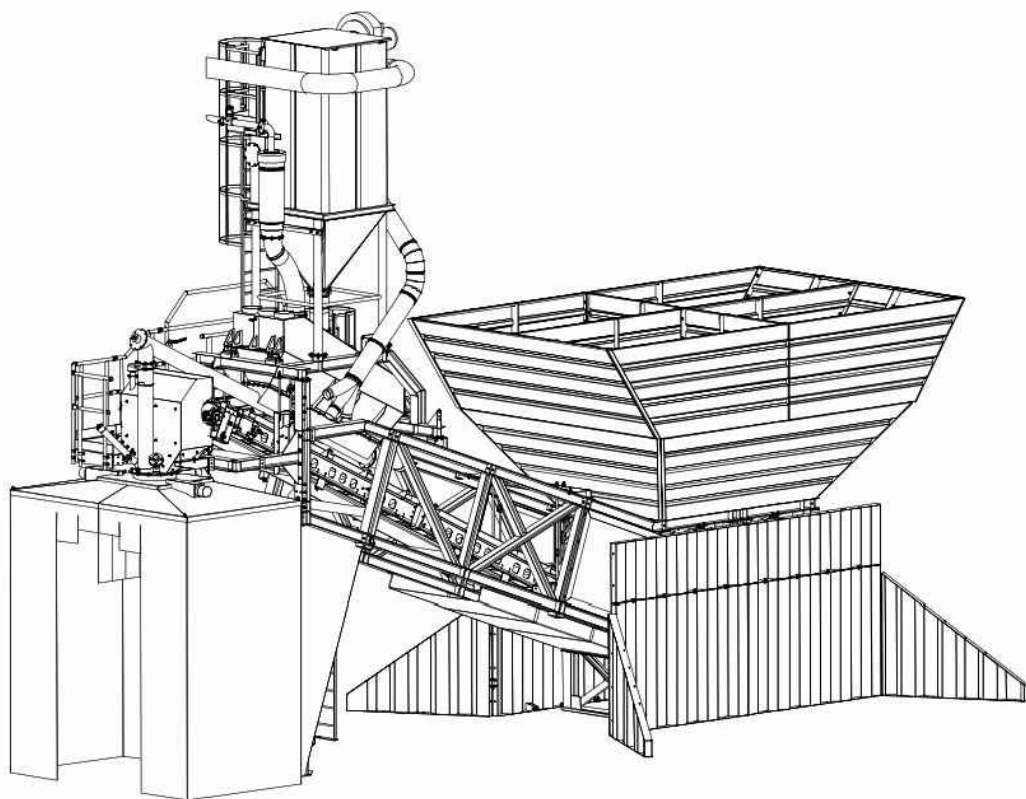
Planimetri të impiantit të prodhimit të betoni
